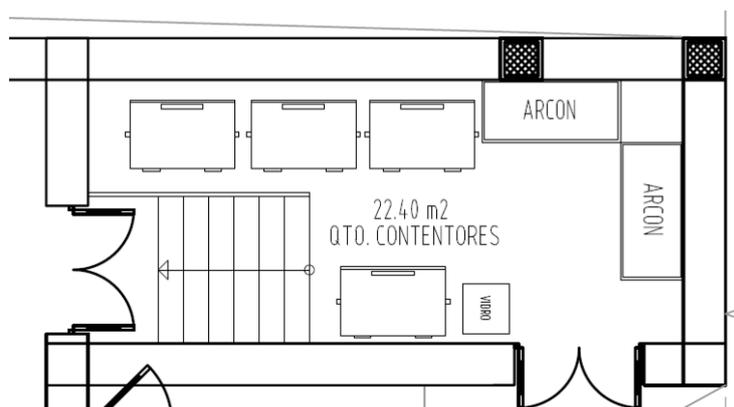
Sala de contentores (extrato da planta de implantação – piso 0)
